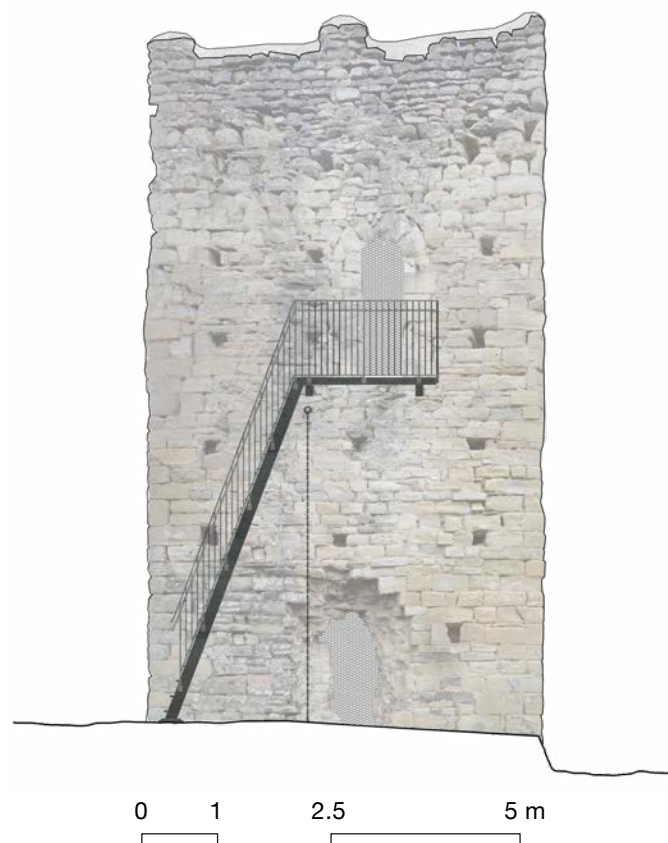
Prospetto Sud: l'accesso al mastio
